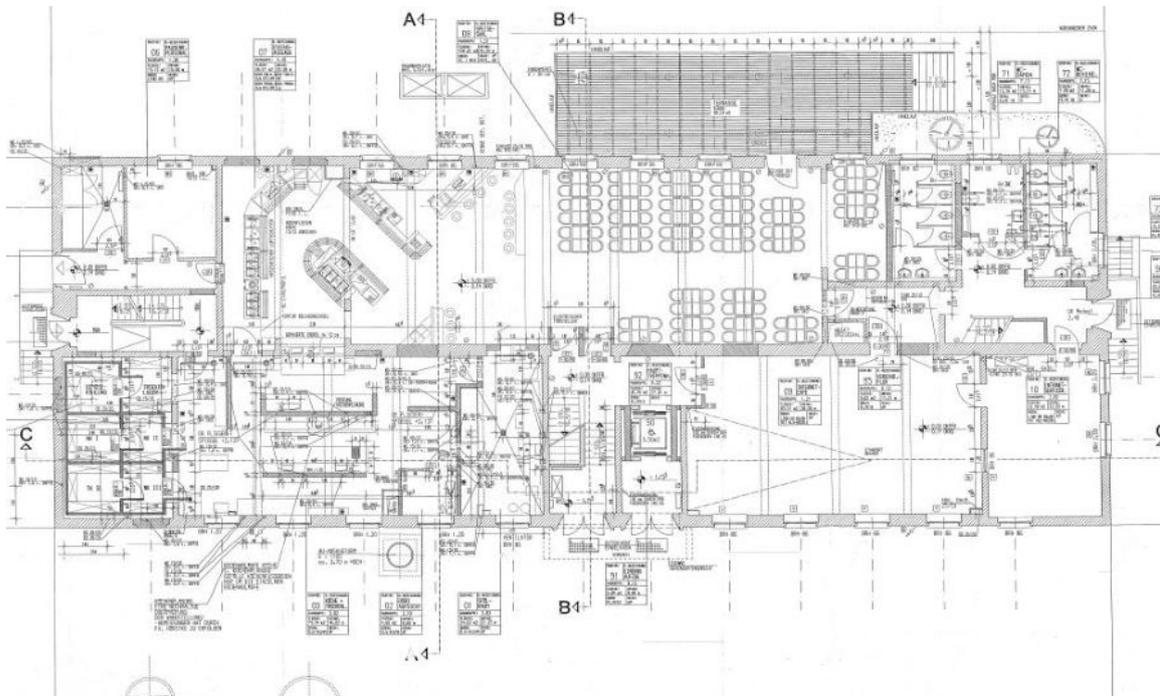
Grundrissplan Erdgeschoss, Gebäude FME
